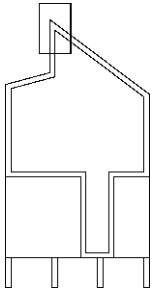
| Detail Dachanschluss. Hand|Werk|Raum. M1:20.
